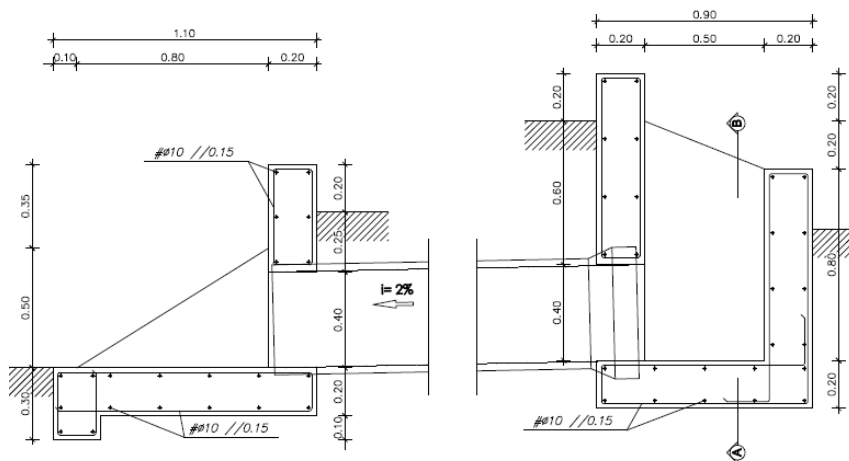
Corte longitudinal de aqueduto em manilhas de betão com 400mm de diâmetro (cotas em metros e varões em mm).
